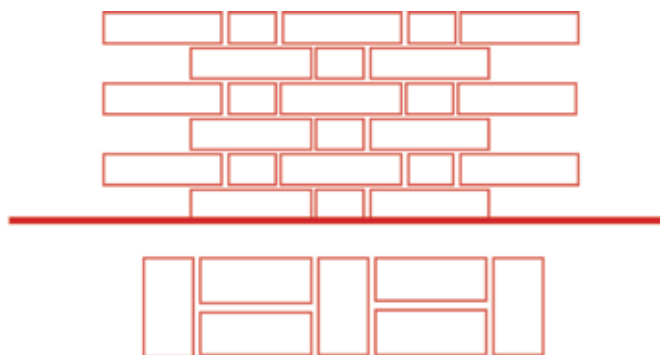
Esquema do aparelho flamengo; vista e planta.
